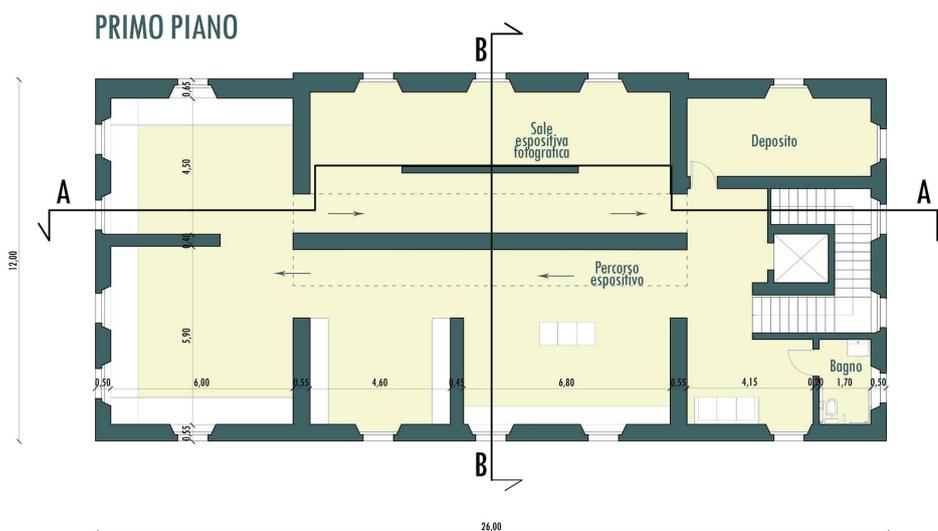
Pianta piano primo del Museo della Ferrovia
